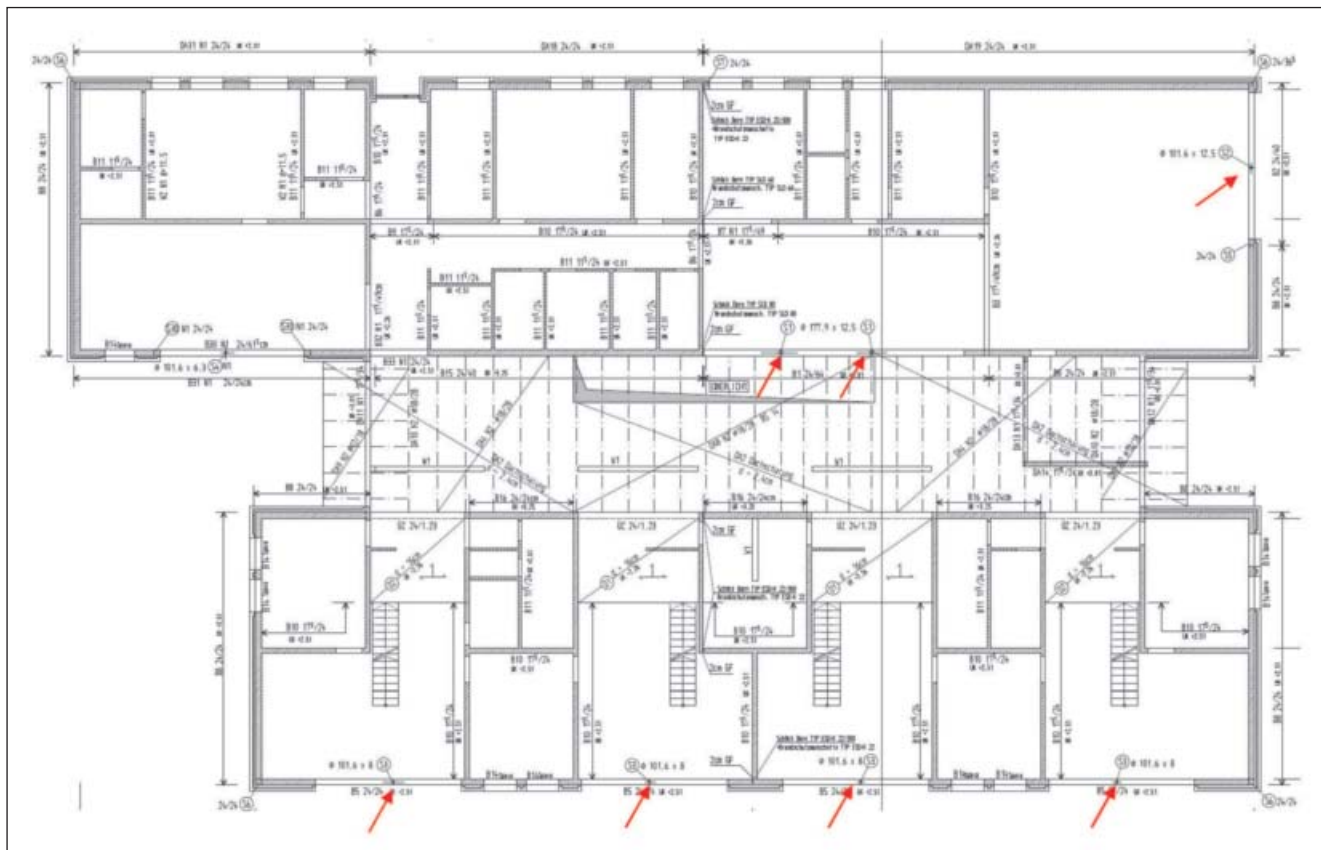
Grundriss des im Text besprochenen Kindergartens
